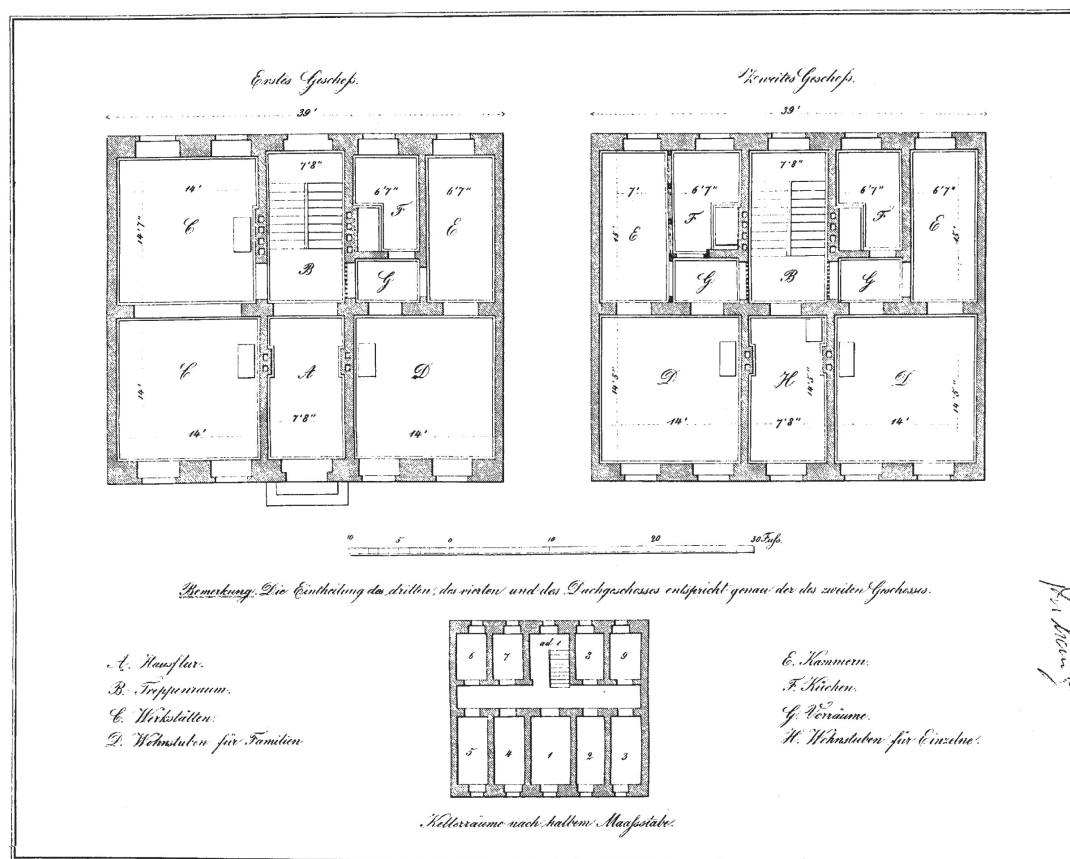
Berliner gemeinnützige Baugesellschaft, BgB, 1847. Modelo de tipo reformador. Plantas sótano, baja y tipo.
